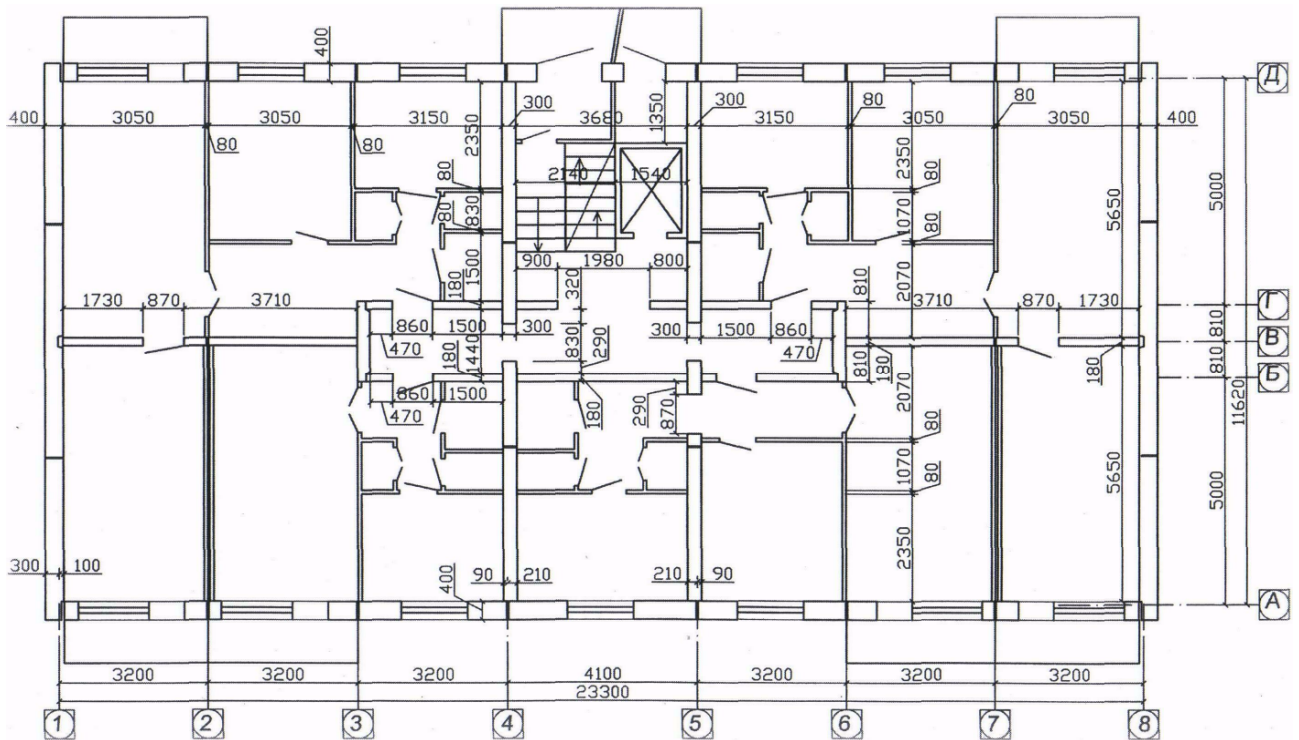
План першого поверху рядової блок-секції 480 серії
